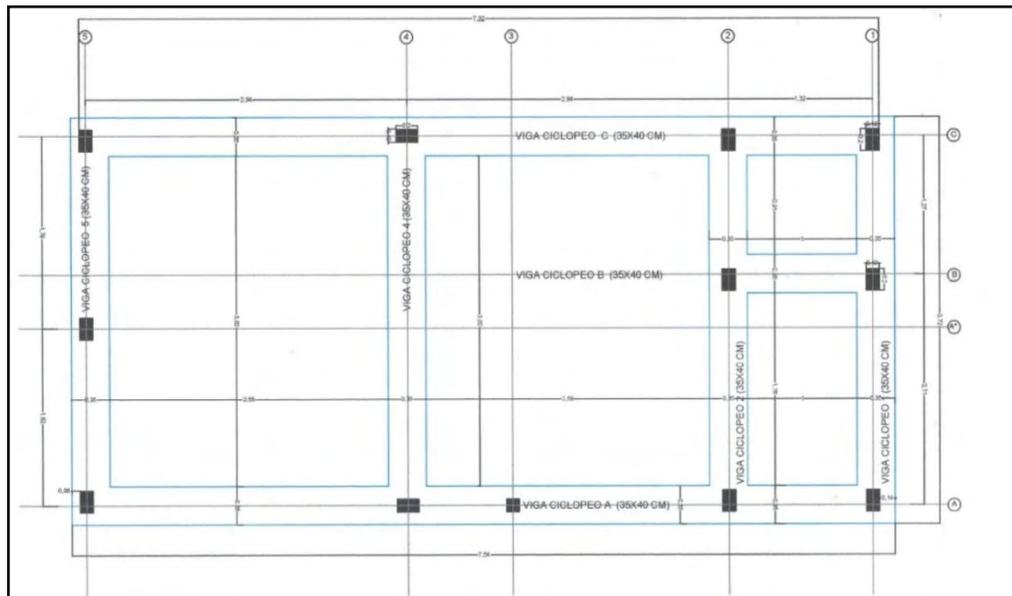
Planta de cimentación concreto ciclópeo modificado.
